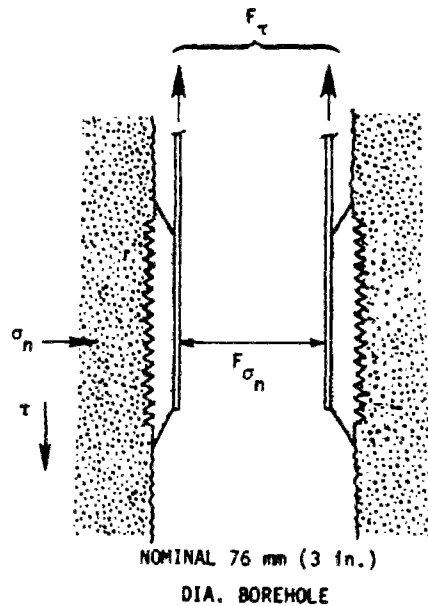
Schéma de l'essai de cisaillement sur les parois d'un forage (d'après Lutenecker et Hallberg, 1981).
